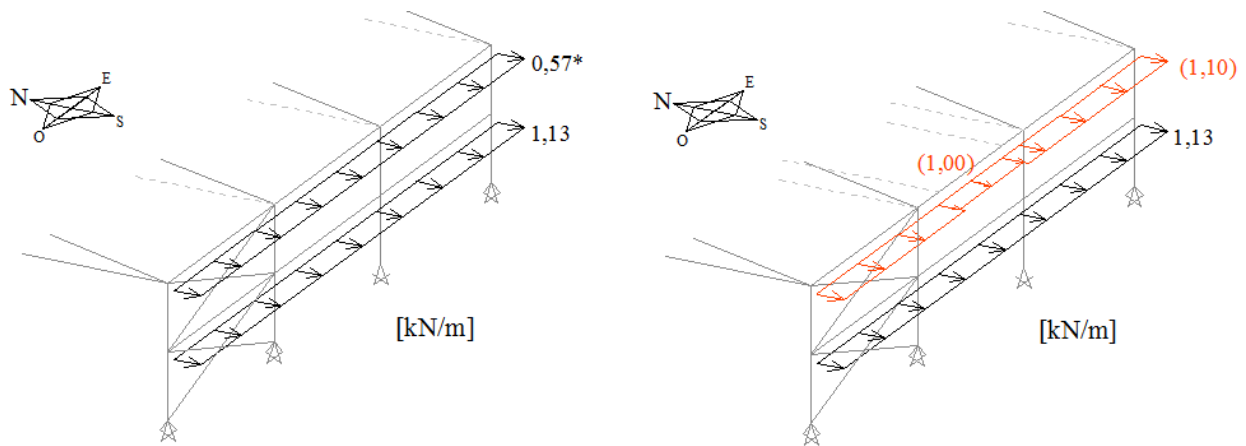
Vento W2 na fachada orientada a Sul na situação 2 (RSA)
